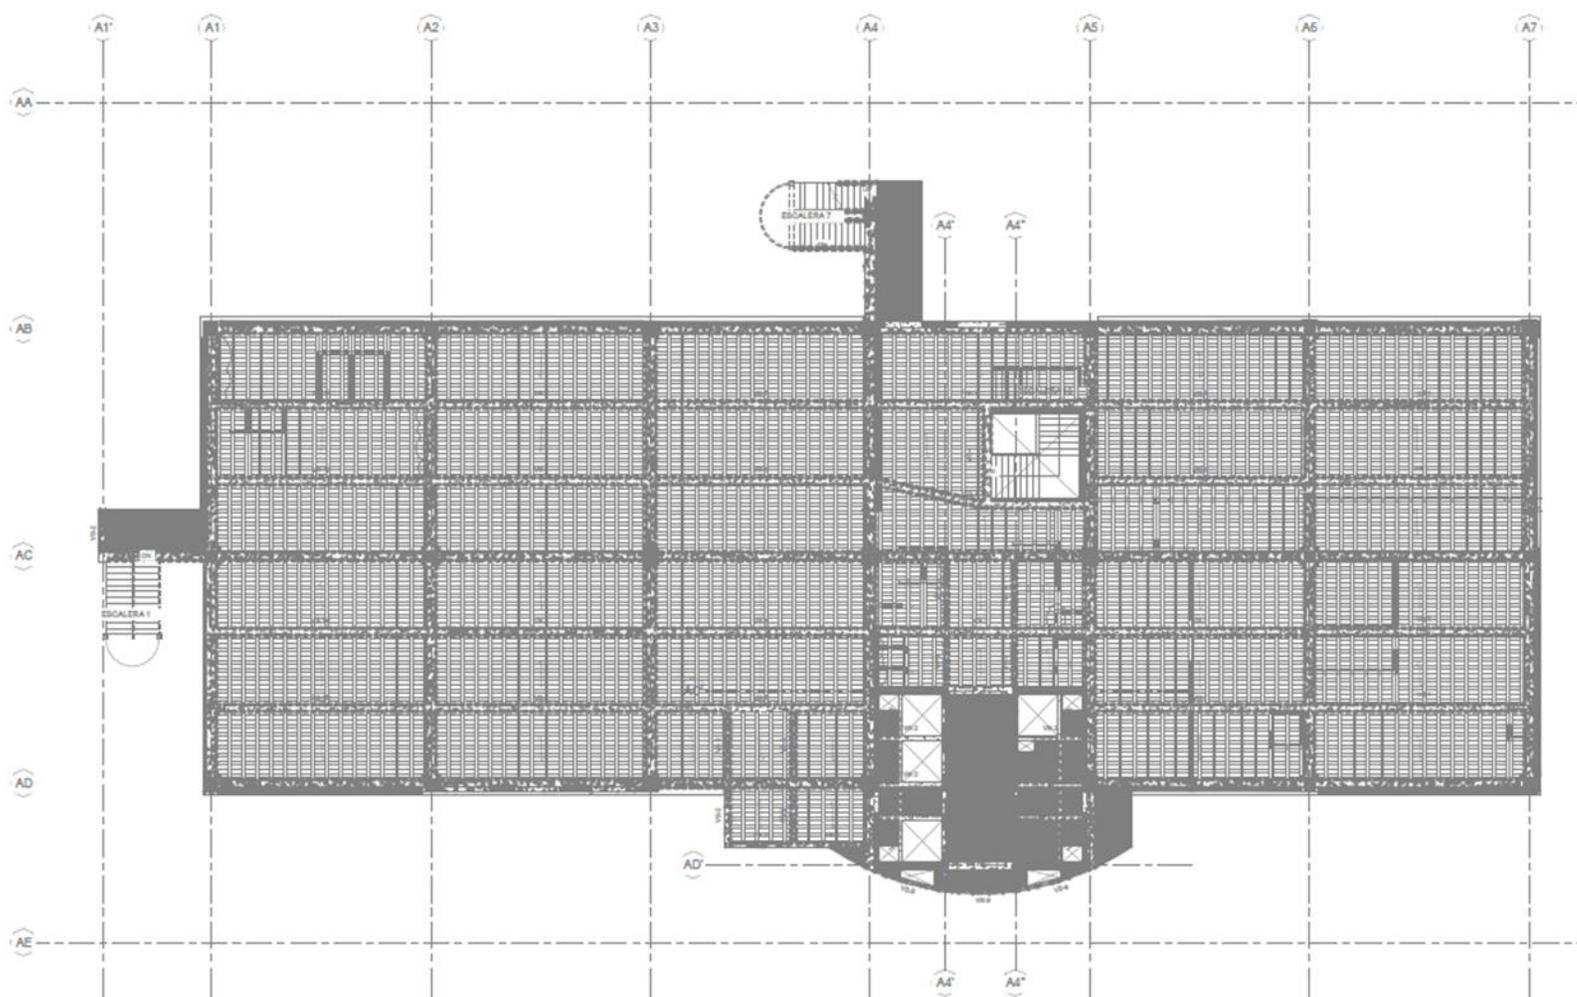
Detalle de losa aligerada de nivel ocho.
